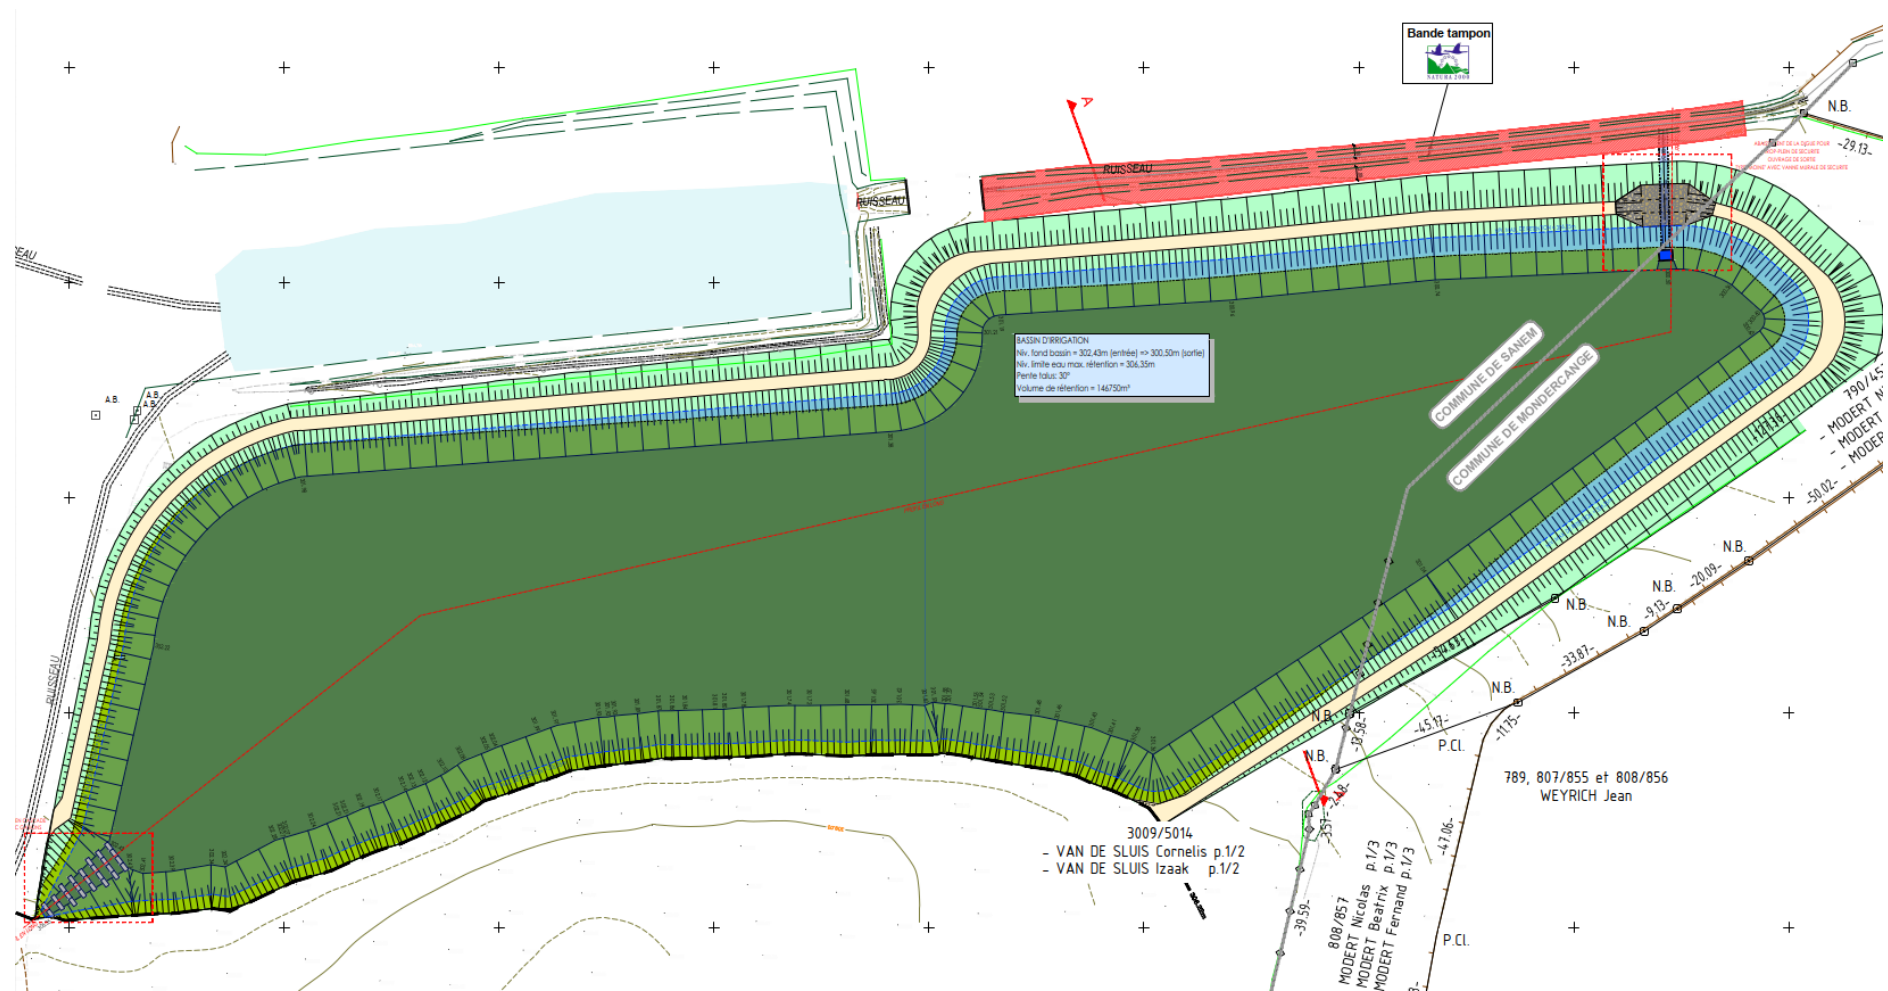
Auszug aus dem Plan „Concept d'assainissement - vue en plan et profil en long“ (Variante D) (LUXPLAN S.A. Stand 01/2020): Draufsicht, hier sollte ein Volumen von 146.750 m³ vorgesehen werden.
